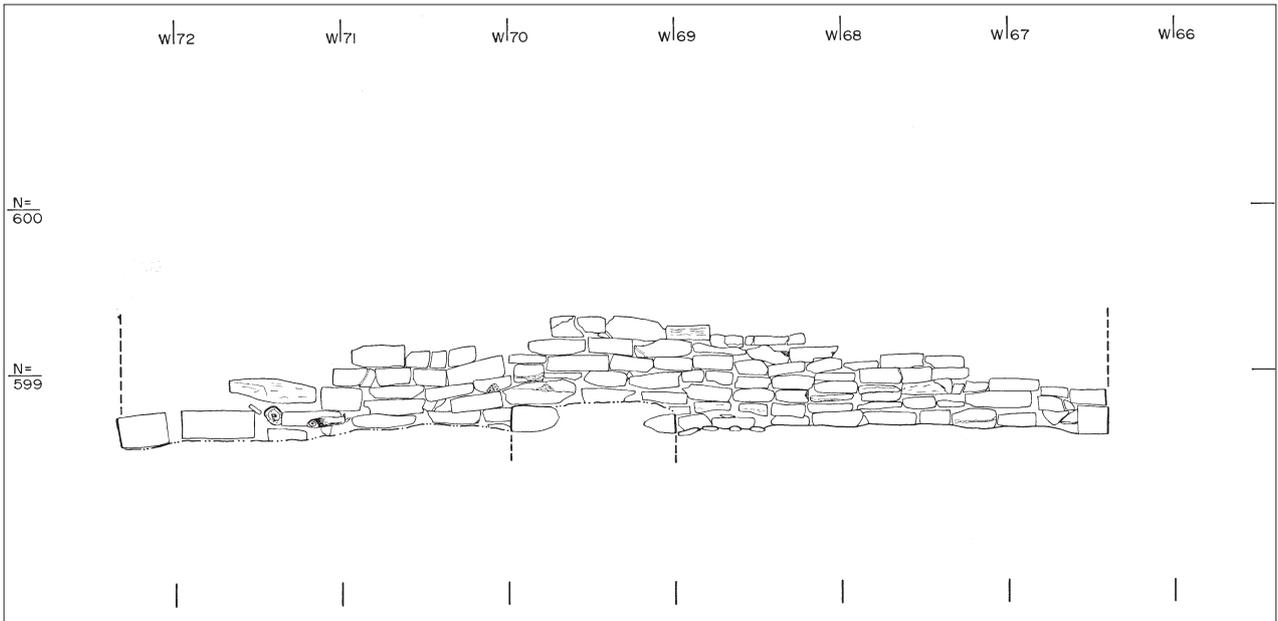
Fachada con vista al Norte de pared Sur de estructura
